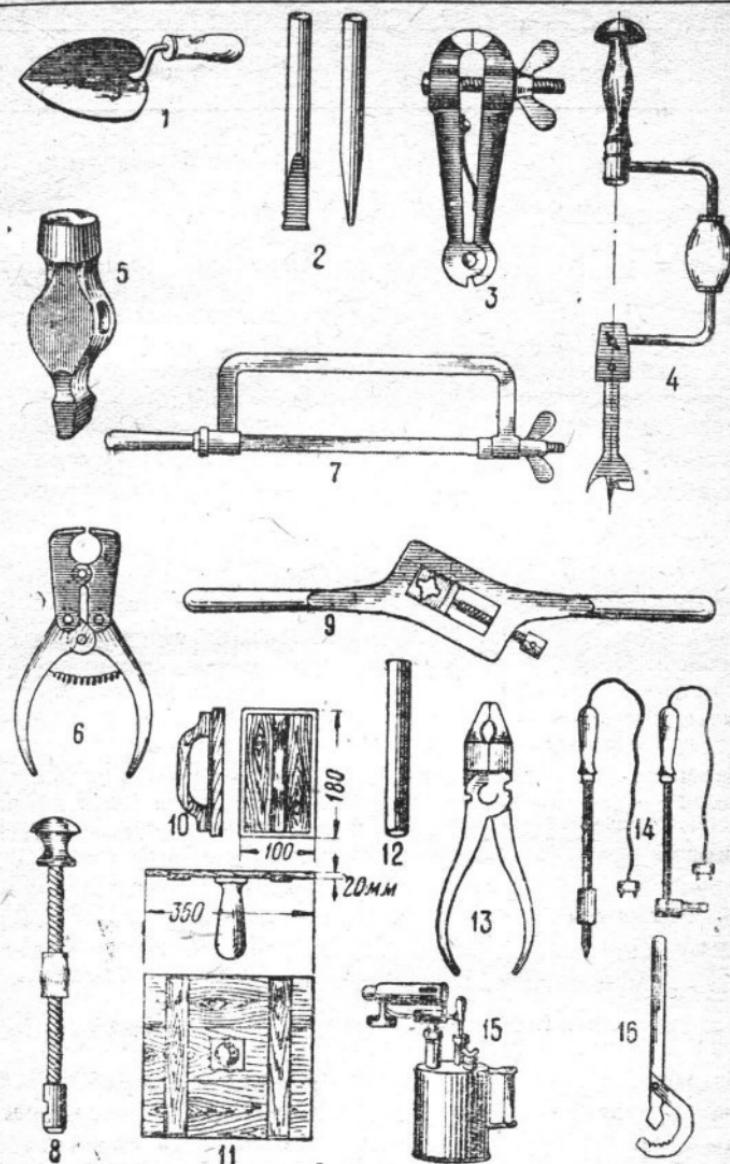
Инструмент: 1 — лопаточка; 2 — зубило; 3 — тисочки ручные; 4 — коловорот; 5 — молоток; 6 — кусачки; 7 — ножовка; 8 — дрель; 9 — клупп; 10 — затирка; 11 — сокол; 12 — шлямбур; 13 — пассатижи; 14 — паяльники электрические; 15 — паяльная лампа; 16 — ключ водопроводный.
